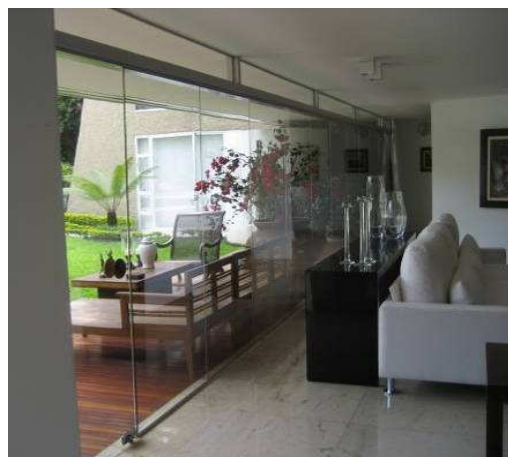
VISTA INTERNA DO FECHAMENTO DO PAVIMENTO TÉRREO
